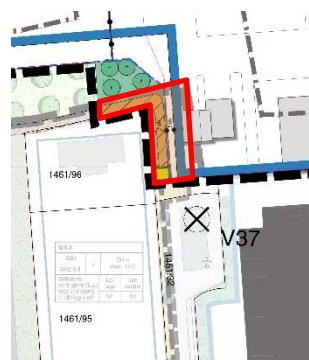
Teilausschnitt Bebauungsplan Gewerbepark Rational, 2. Änderung und Erweiterung
